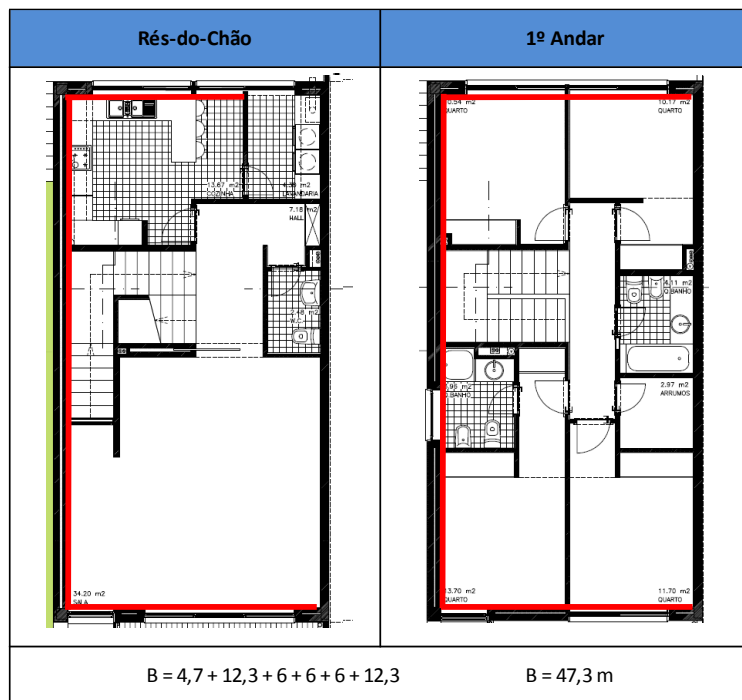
Ponte térmica linear de fachada com pavimento de nível intermédio.
